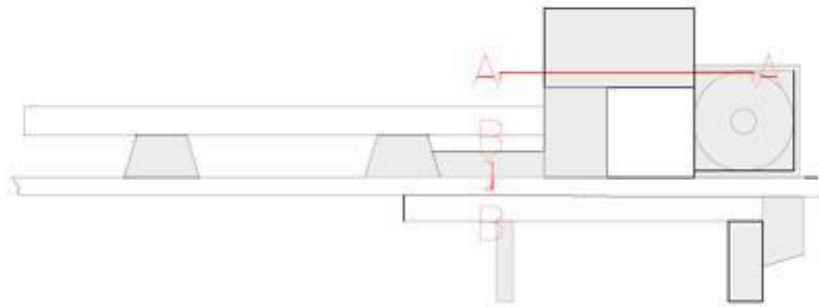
Planimetria piazzola (configurazione "Just in Time") in fase di cantiere
